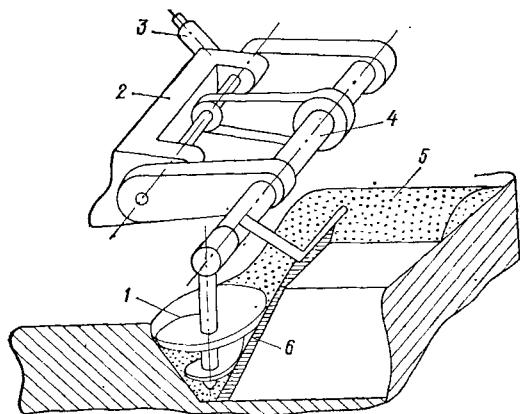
Навесное устройство с конической фрезой для нарезки траншей во льду [63].
